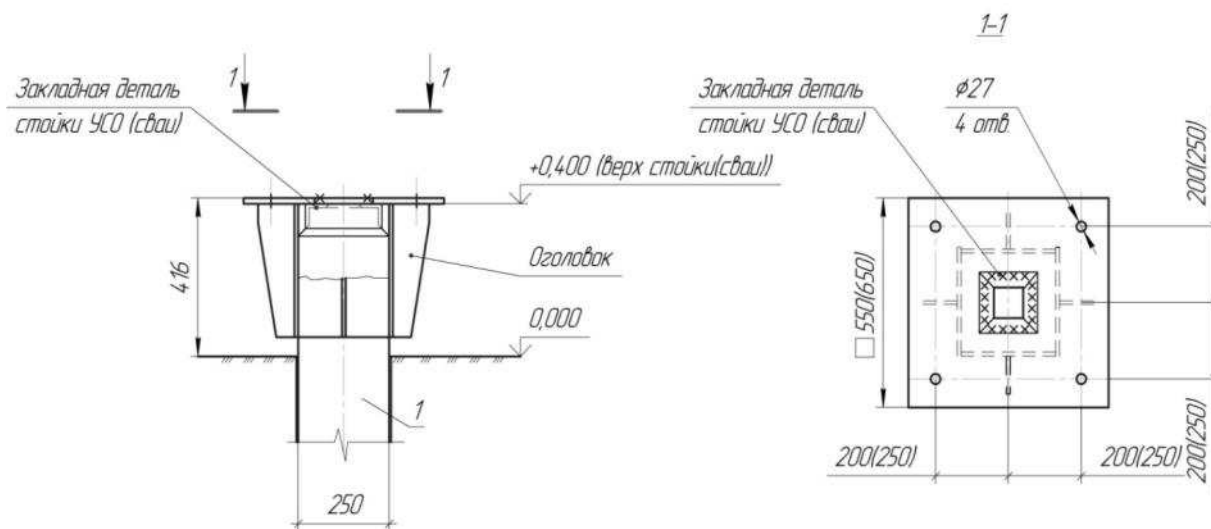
Установка блоков на фундамент из стоек УСО (свай).
